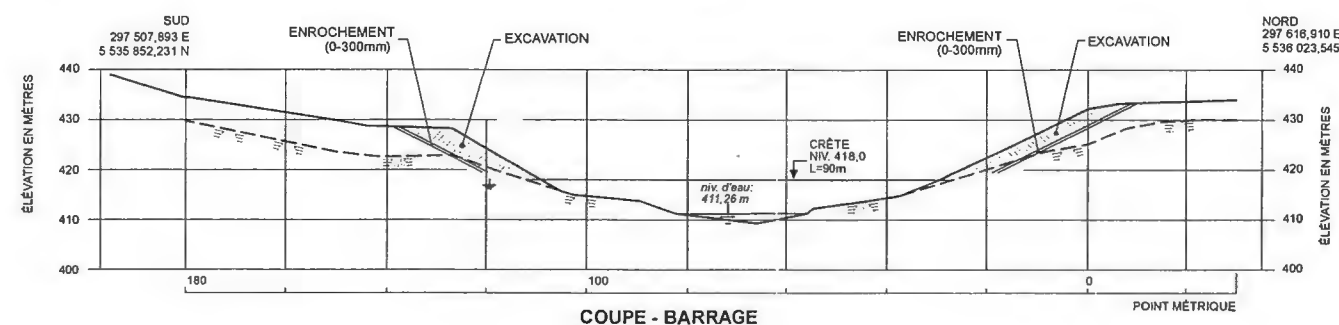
Canaux de dérivation et plans des ouvrages
